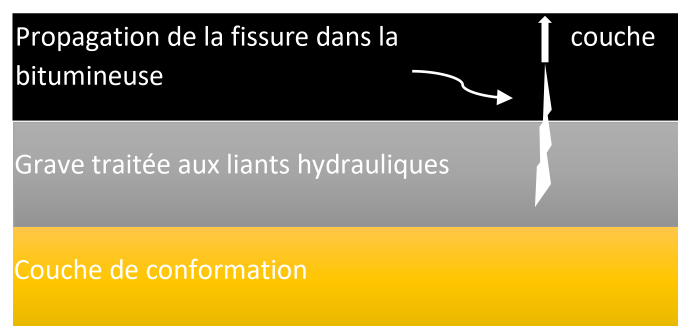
Fissuration réfléchive dans une chaussée semi-rigide [Huang, 2004]
